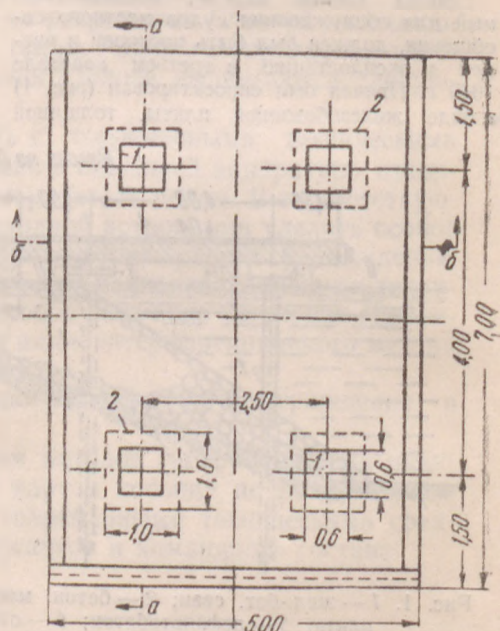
а. План звена железобетонной плиты причала: 1) отверстия в звеньях плиты причала; 2) жел.-бет. площадки на головах свай
